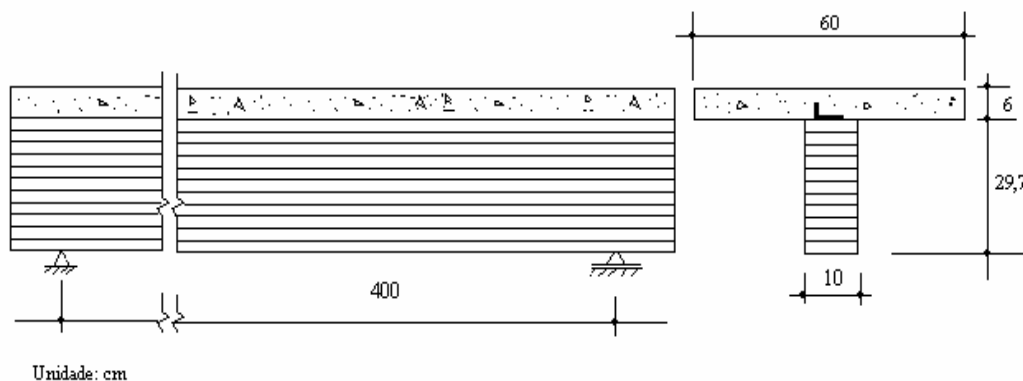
Geometria e dimensões da VC1- MLC/concreto
